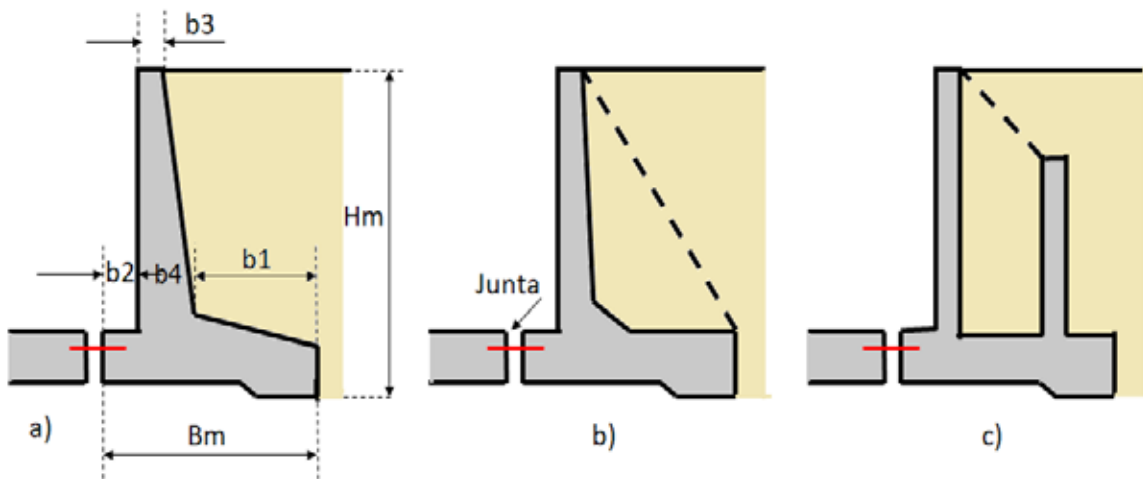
34 Perfil de los muros de ala. Fuente: Kirienko (1987)
